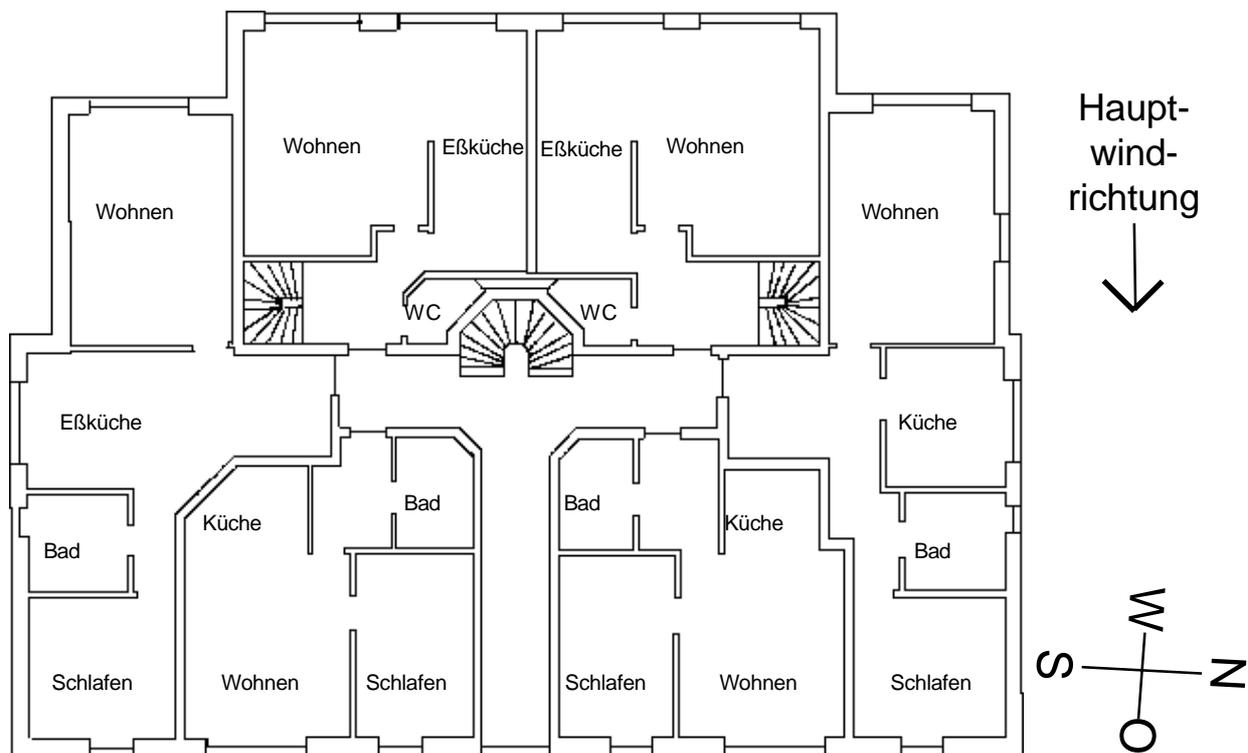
2: MFH-Grundriß mit lüftungstechnisch unterschiedlich bevorzugten und benachteiligten Wohnungen.
